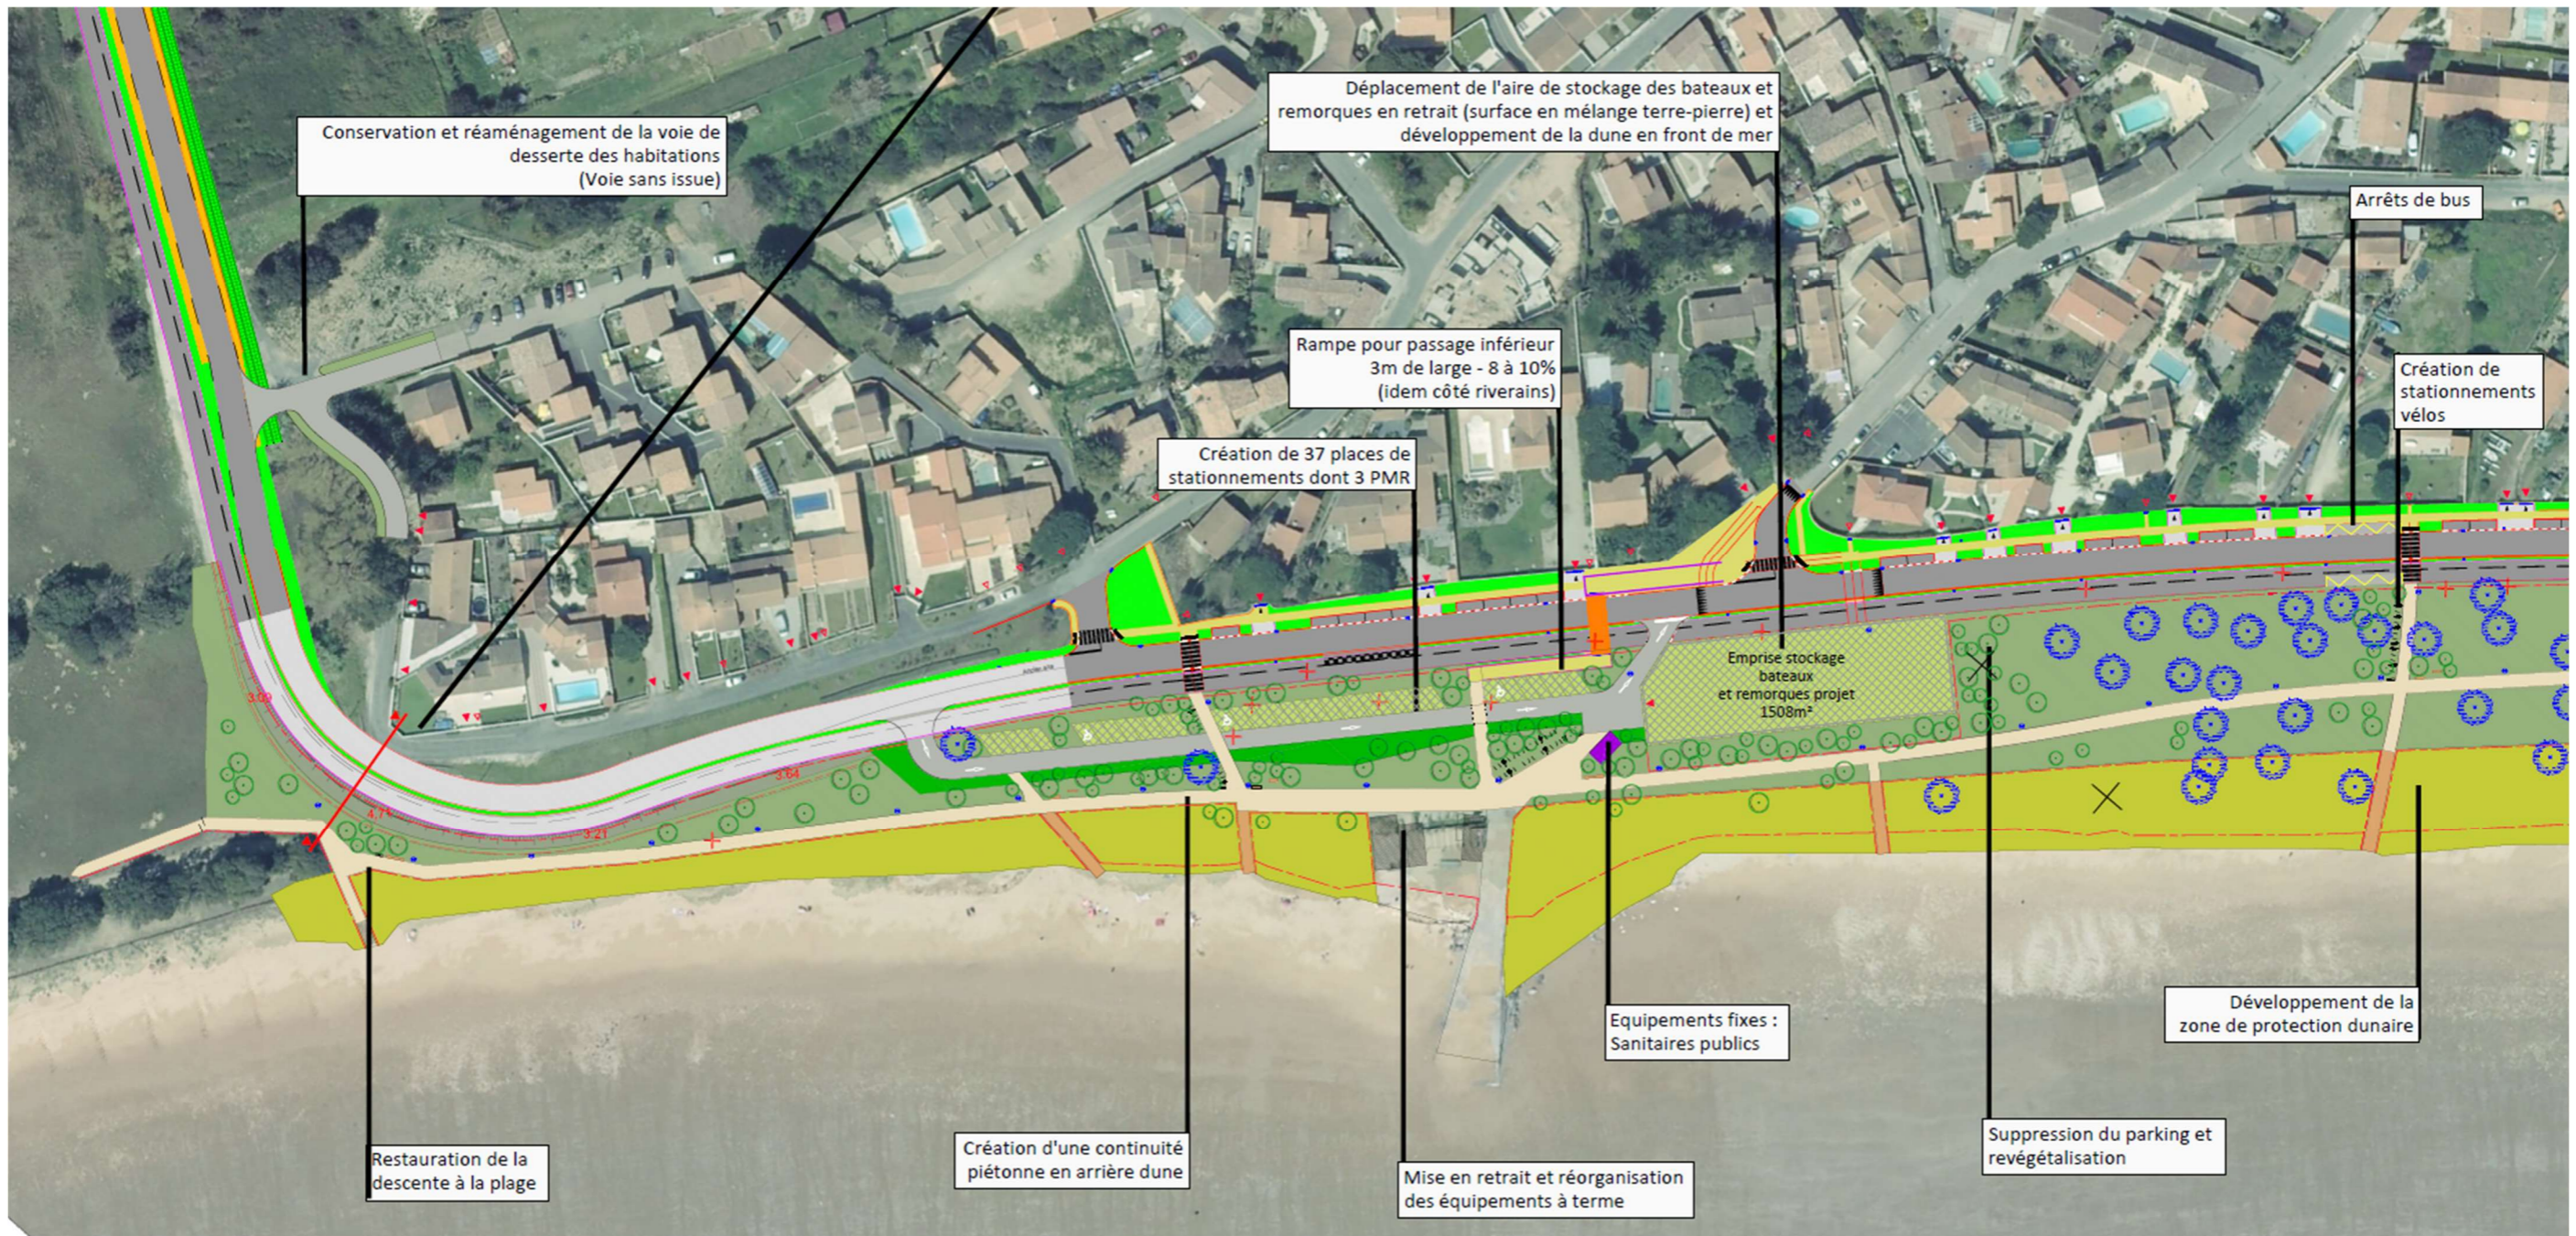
Plan du projet d'aménagement « 2. Aménagement du site propre et requalification de la plage sud de Rivedoux » (1)
